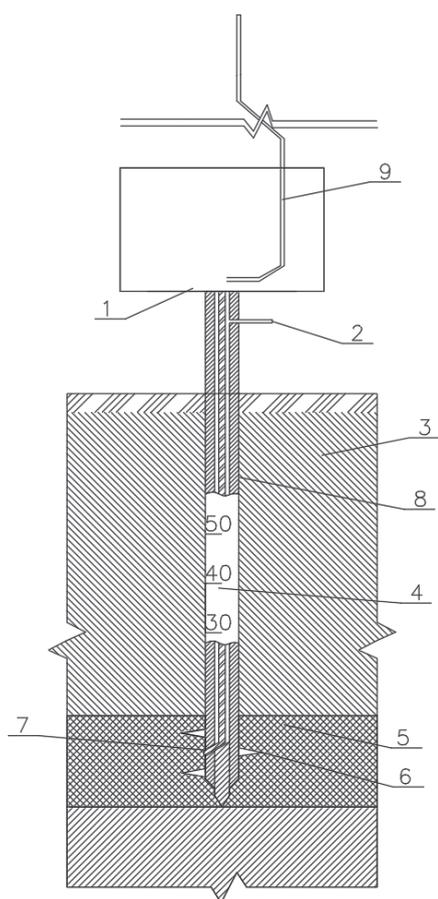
Воздухозаборное устройство шнековое автоматизированное: 1 — мотобур; 2 — газозаборный штуцер; 3 — грунт; 4 — мерная шкала; 5 — зона с неизменным содержанием метана и углекислого газа; 6 — шнековая навивка; 7 — газоотборное отверстие; 8 — полая штанга, 9 — газотводное устройство, для отвода выхлопных газов
